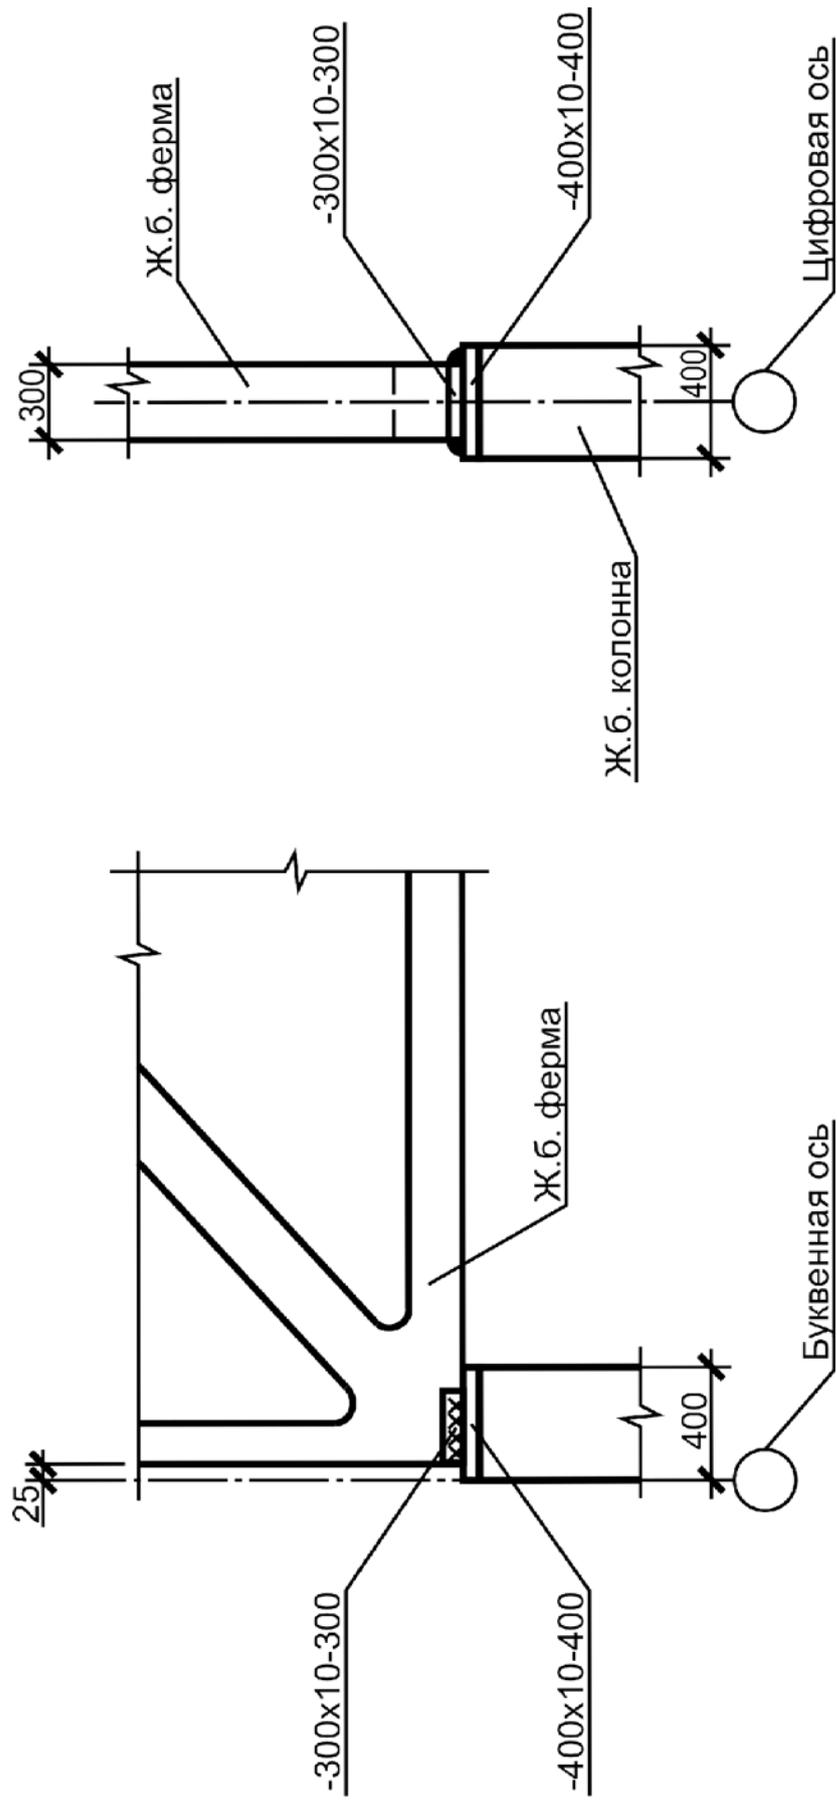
Опираение железобетонной фермы на крайнюю колонну
